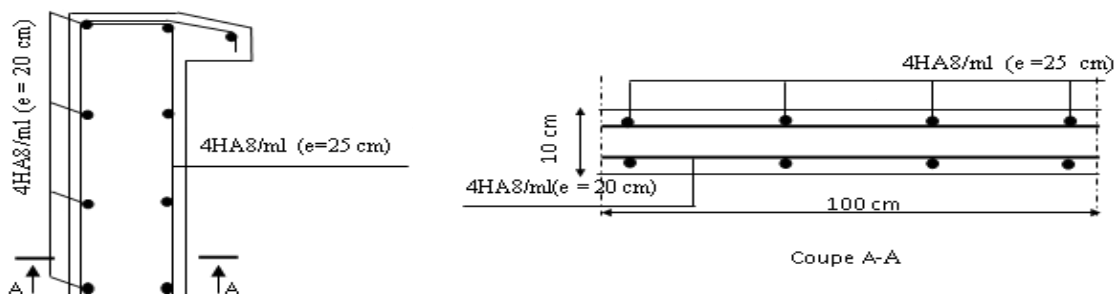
7: schéma de ferrailage de l'acrotère
